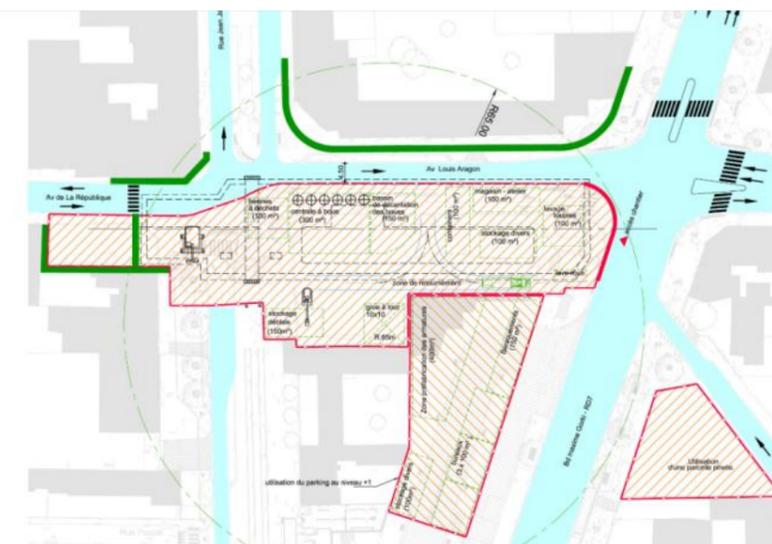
Gare de Villejuif Louis Aragon – Plan d'installation de chantier
